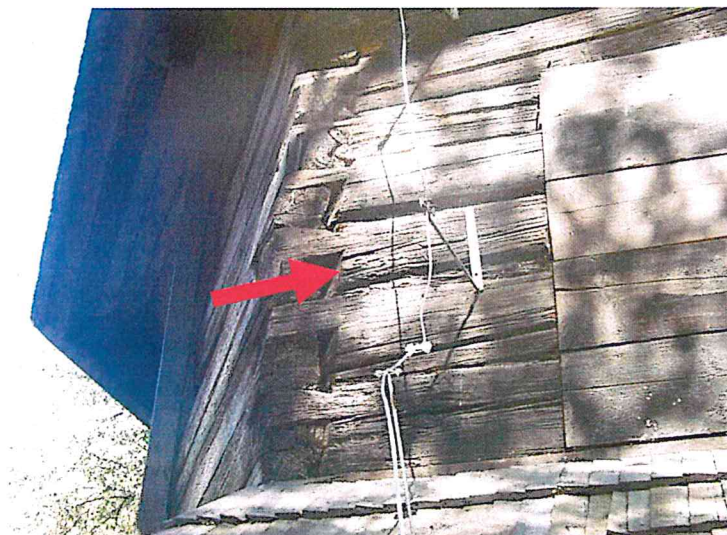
Część górna, lewa – elewacja frontowa, półn-zachodnia
